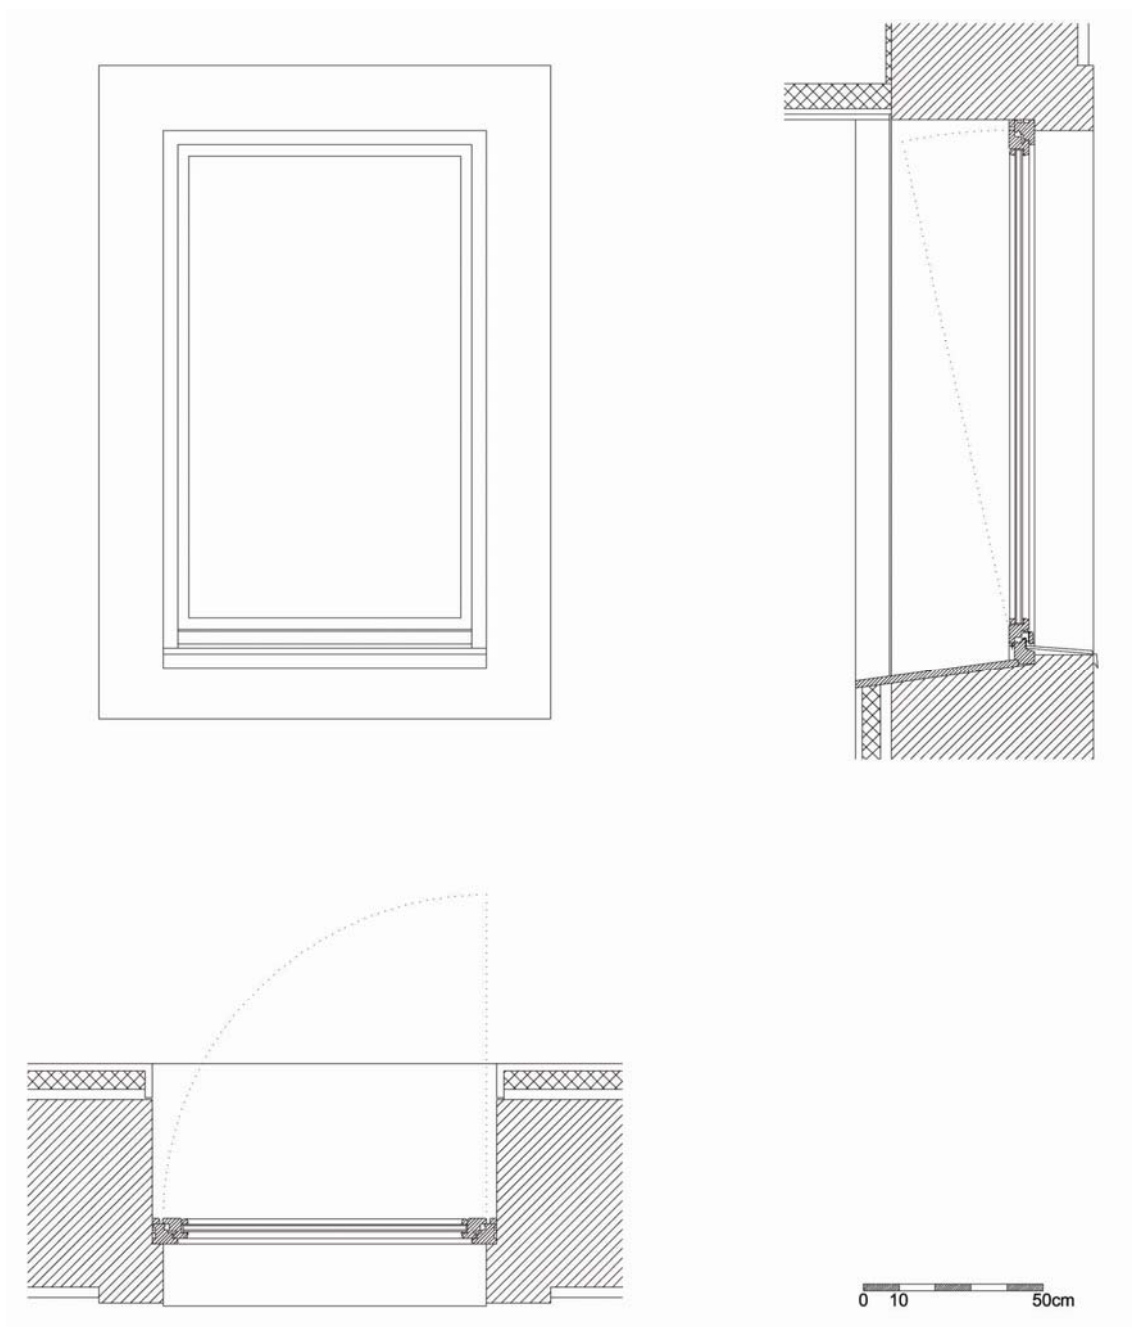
Selecção exigencial de uma nova caixilharia de madeira. Corte horizontal, corte vertical e alçado exterior.
